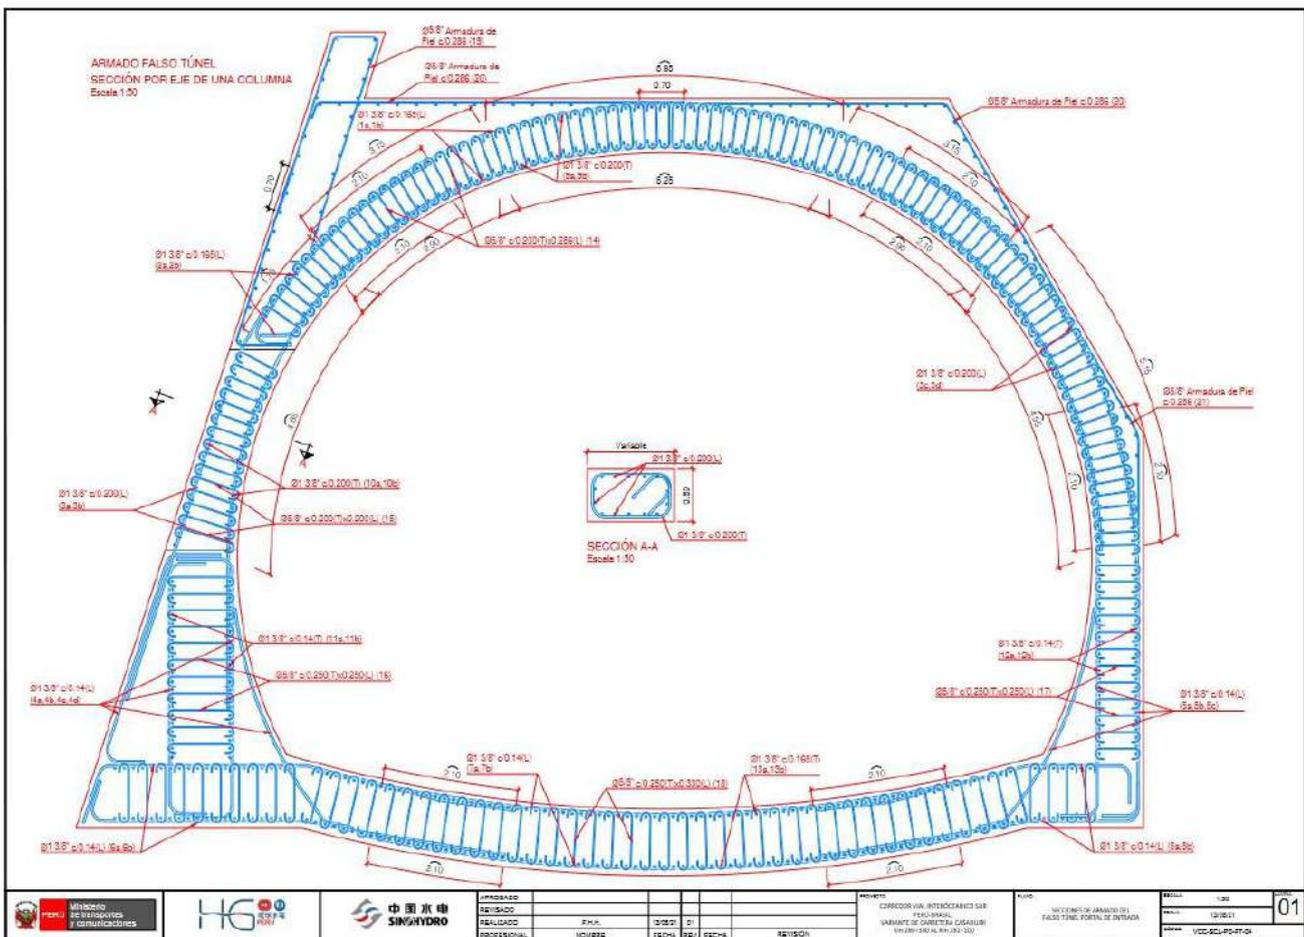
Plano Transversal de la Armadura General del Túnel (Frontal)
